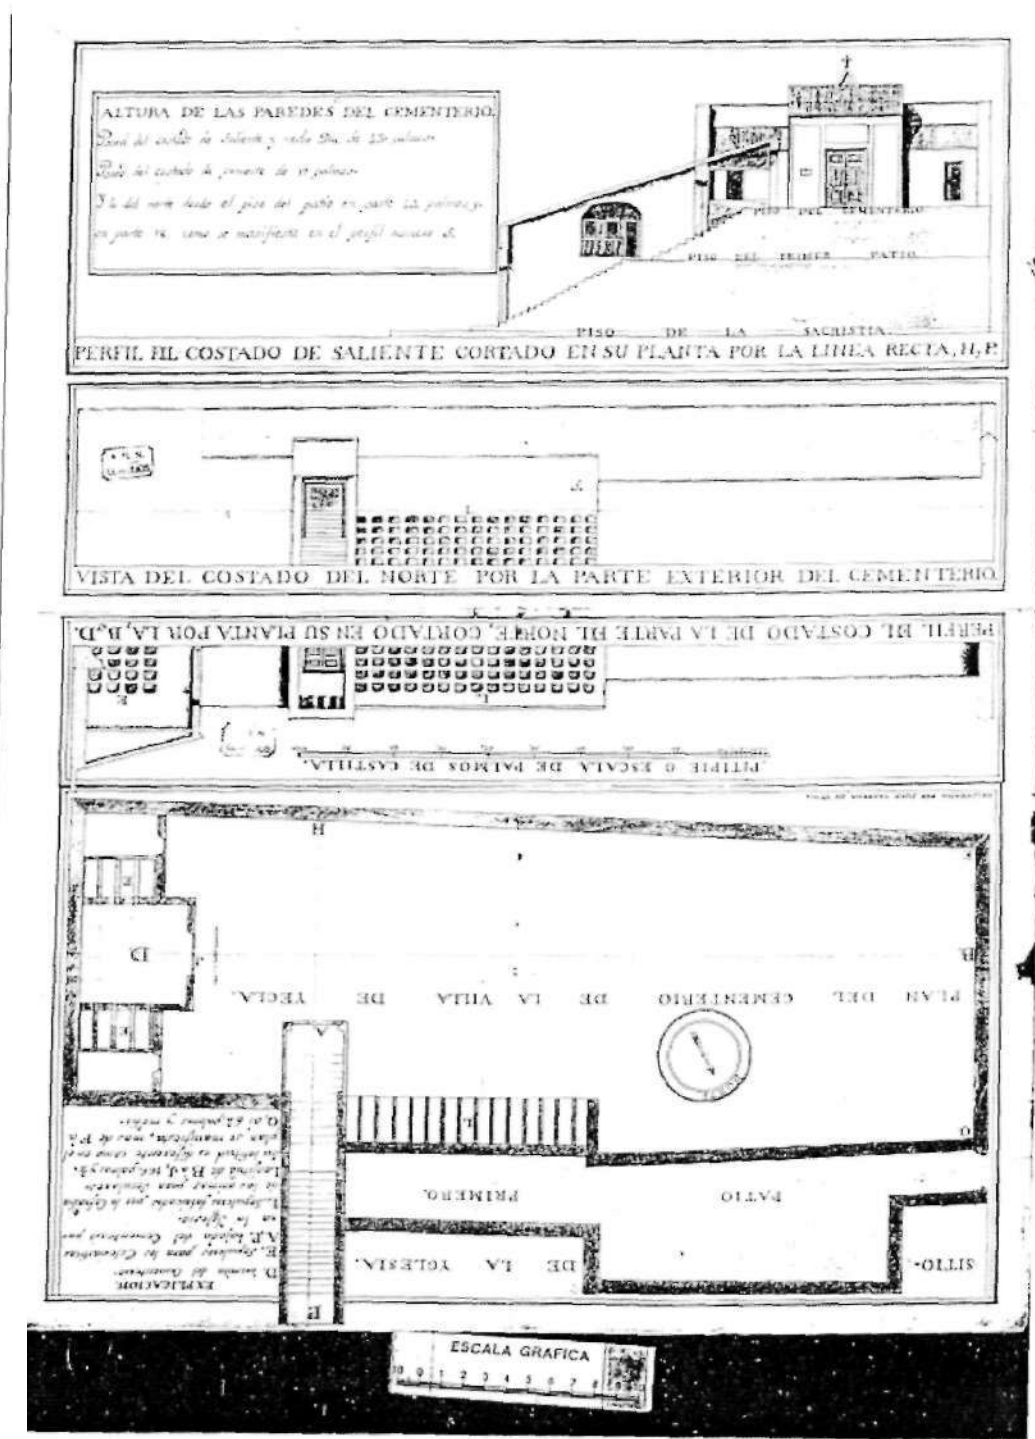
Plano del cementerio de la Asunción. 1802.
